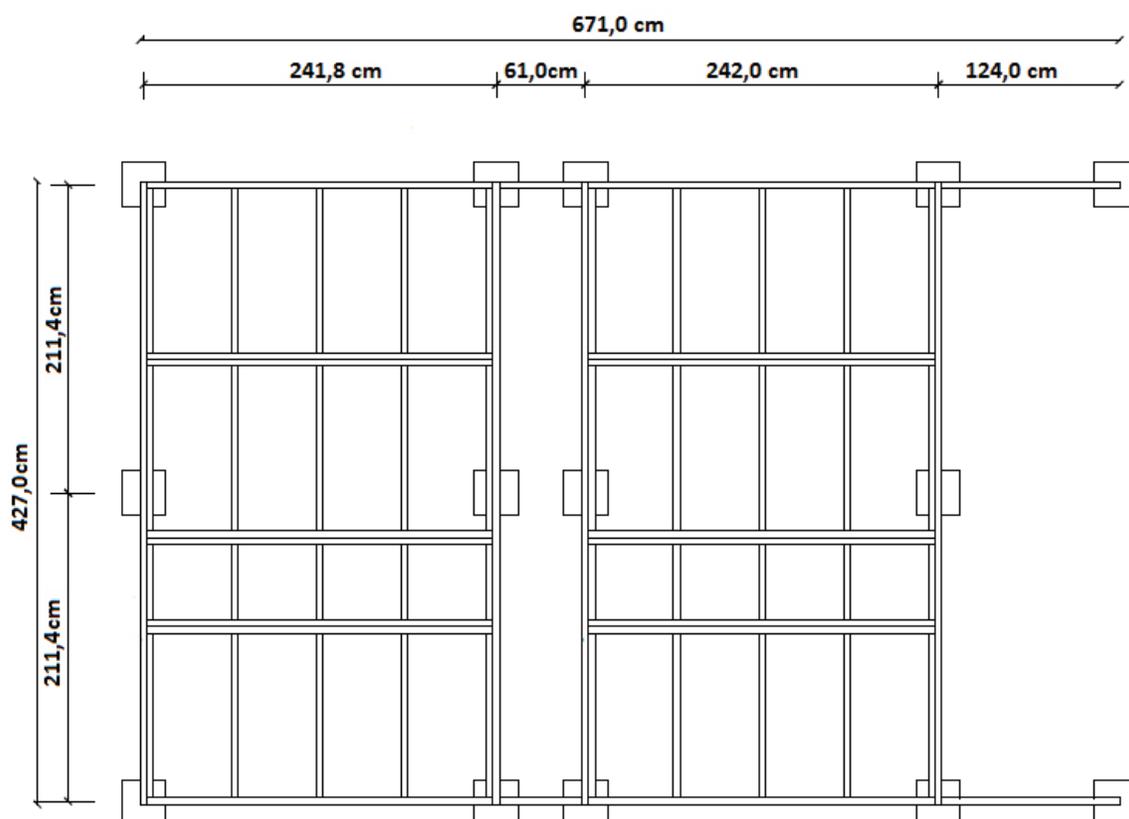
Vista en planta vigas de piso (Vigas periféricas en 2x6" y Vigas interiores en 2x4")
